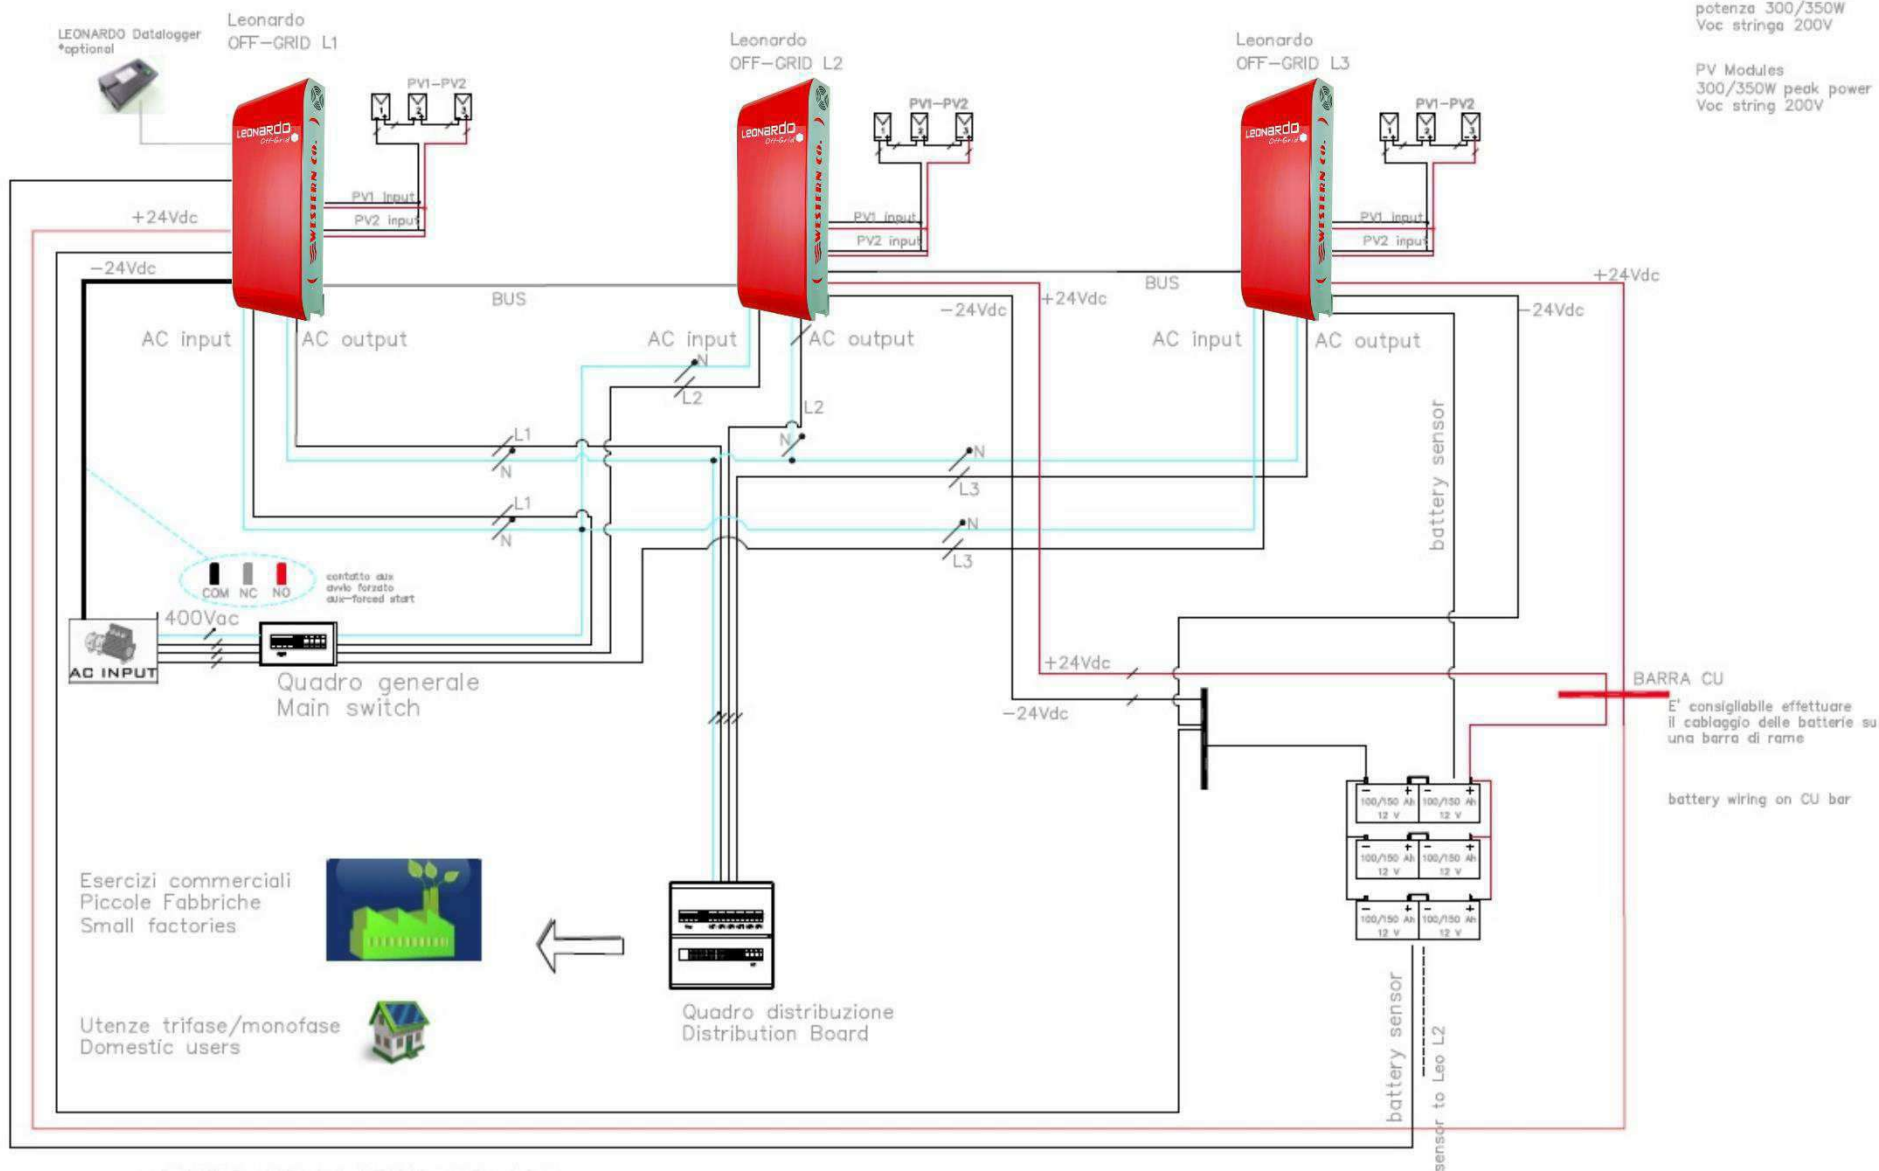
Schema Unifilare dell'impianto trifase 4,5Kw
